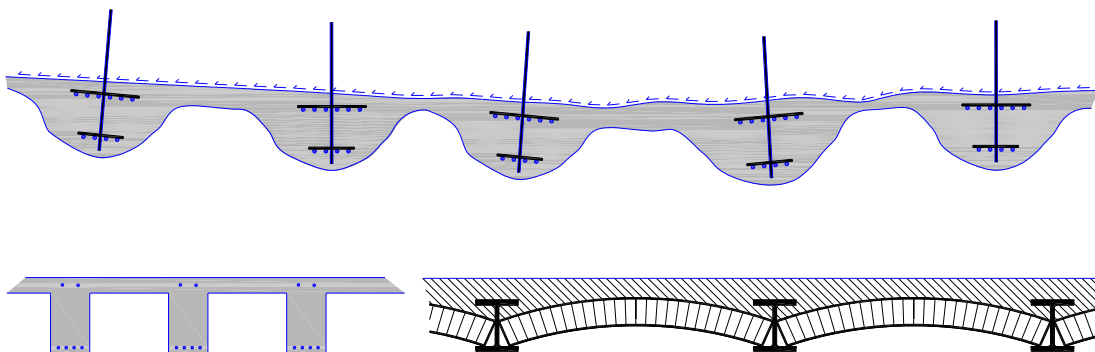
Hvelvvirkning i tunnelens lengderetning, mellom sprøytebetongbuene. Riktig dimensjonerte buer gjør at sprøytebetongen danner hvelv med tilstrekkelig pilhøyde.
